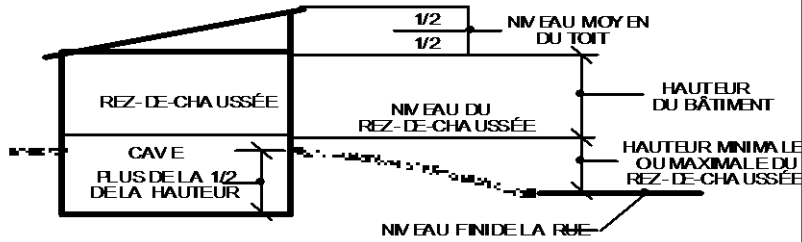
Définition d'étage, de hauteur et de rez-de-chaussée
